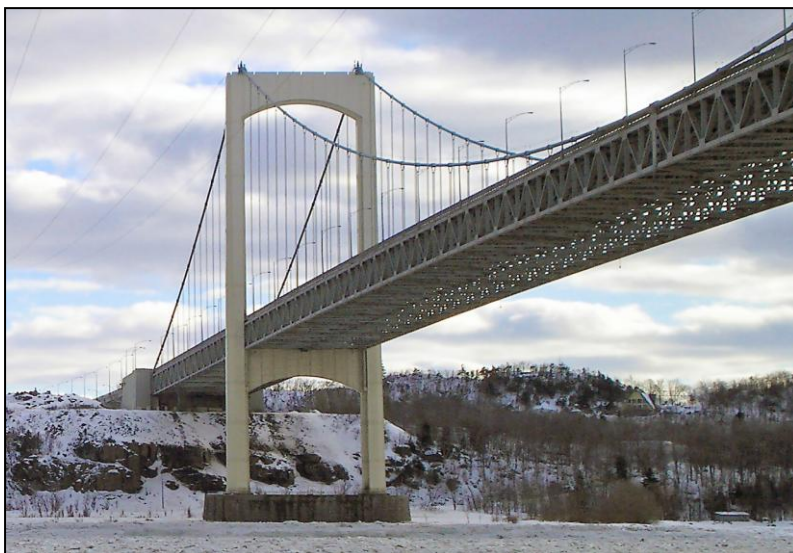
Pont routier Pierre-Laporte, Québec city;
